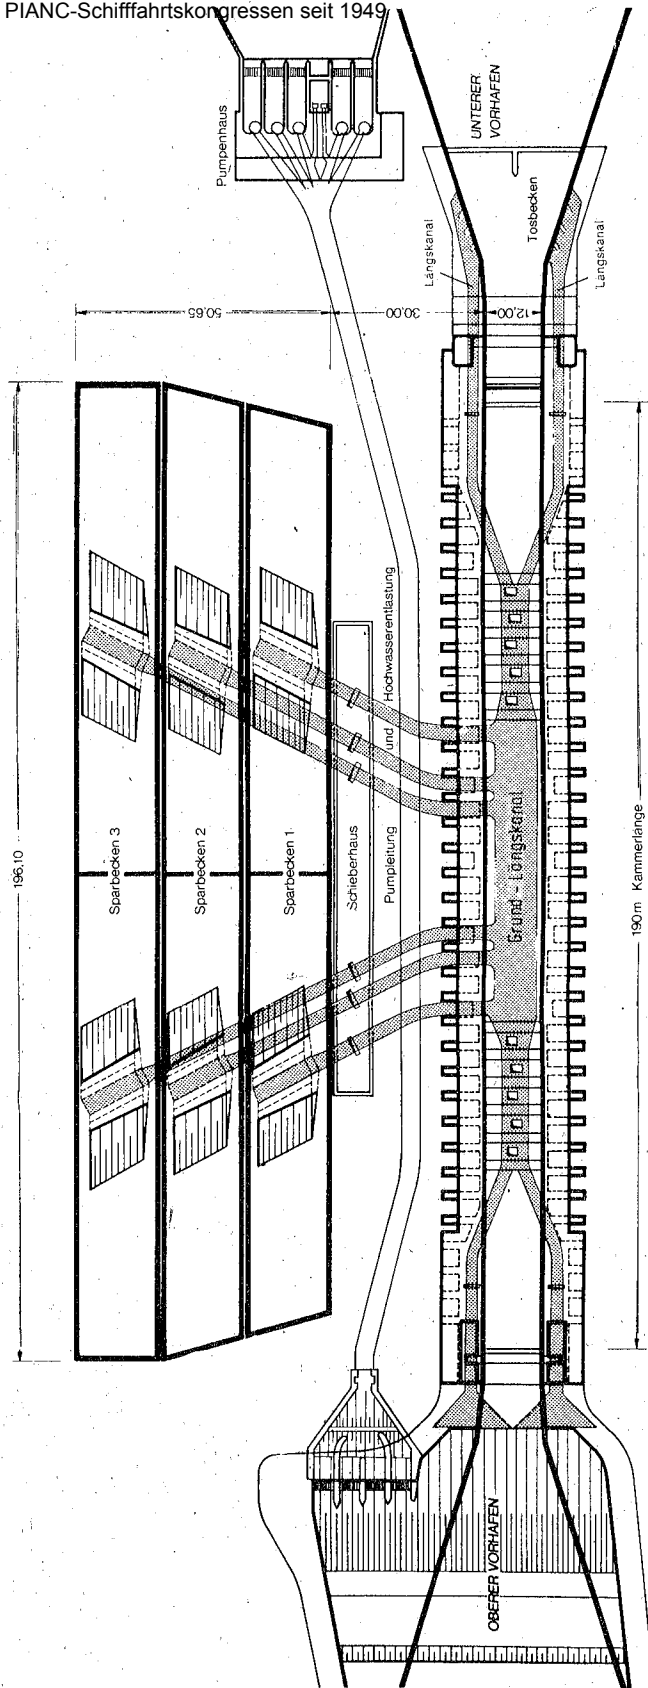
Grundriß der Schleuse Uelzen mit Füllsystem
